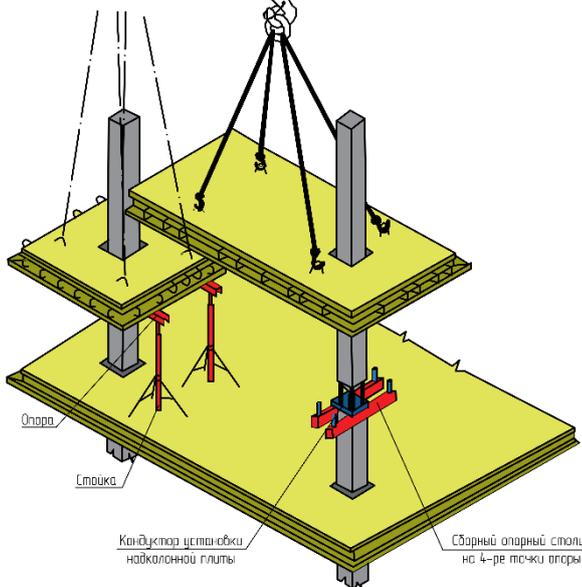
Фото и схема монтажа сплошных железобетонных плит перекрытий как на инвентарные стойки и балки опалубочной системы, так и специально разработанный опорный столик системы КУБ
